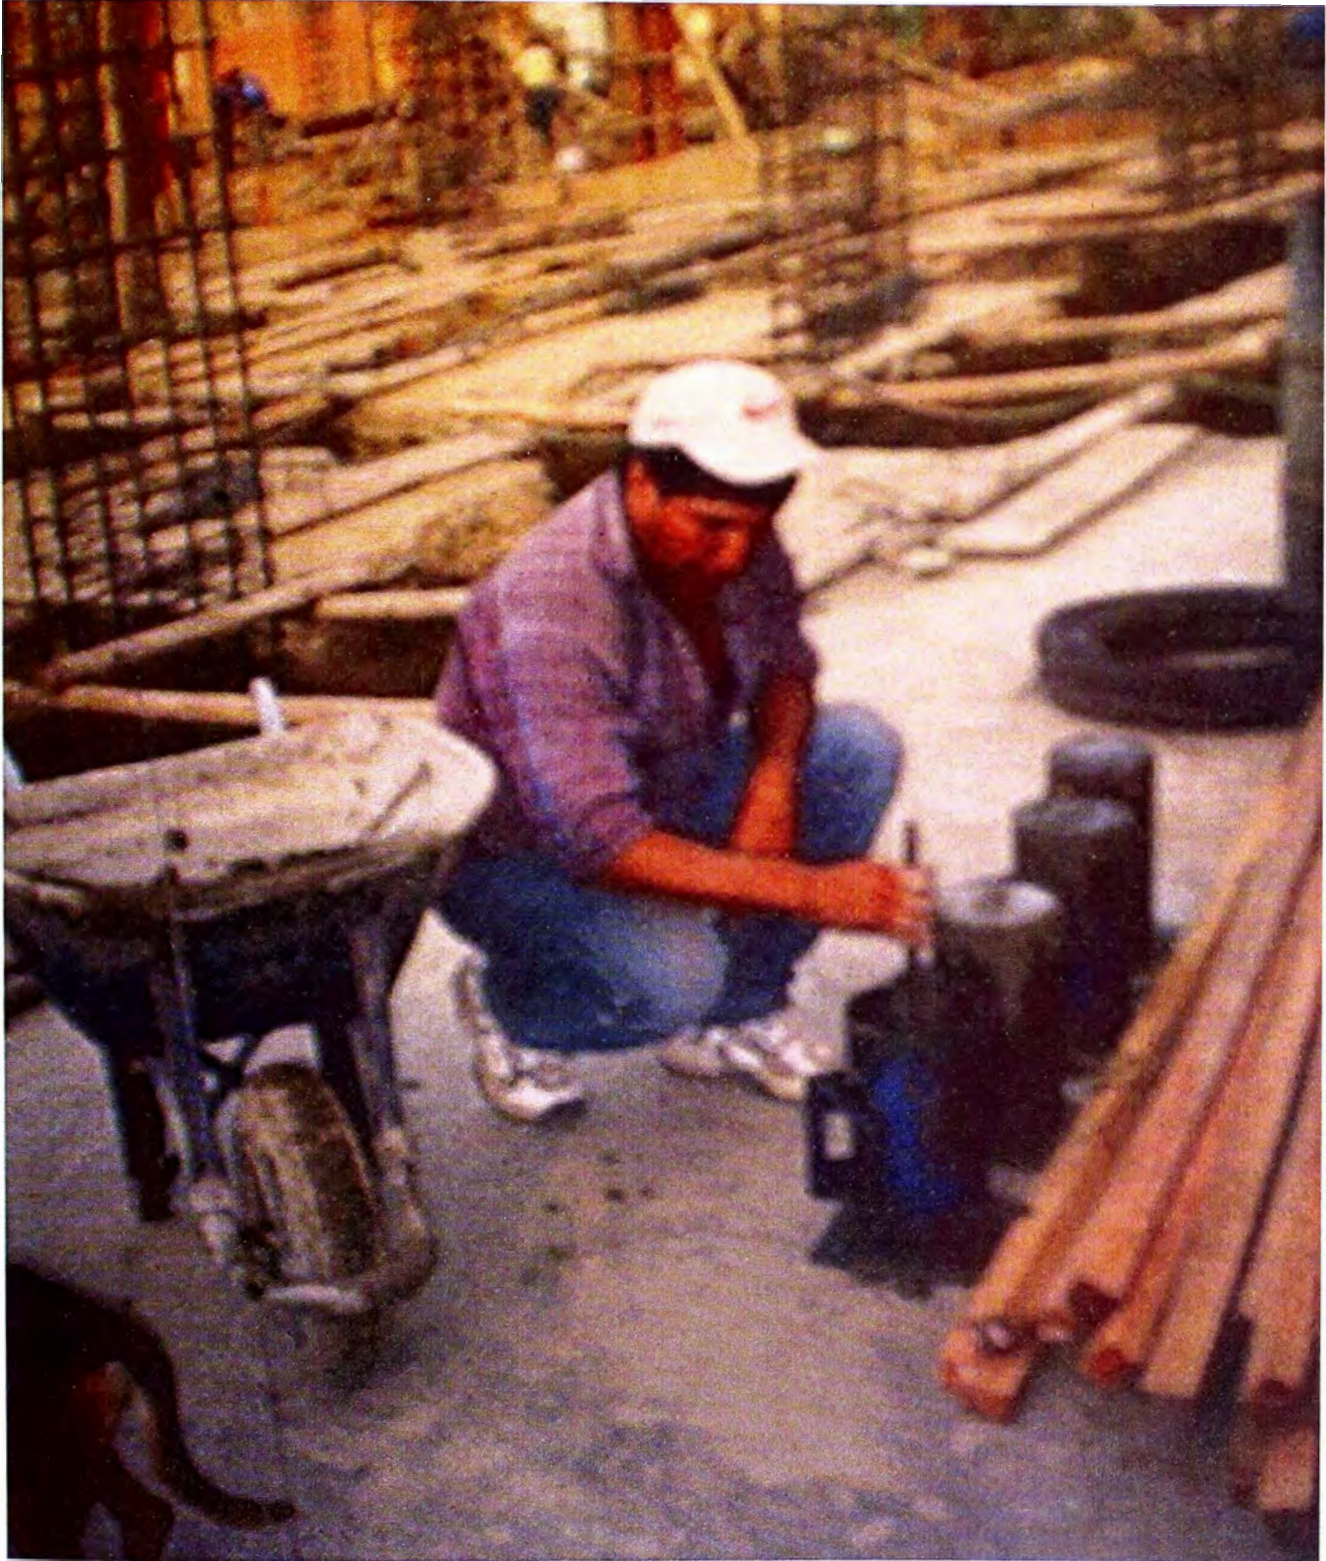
VISTA DE PREPARACION DE TESTIGOS DE CONCRETO
